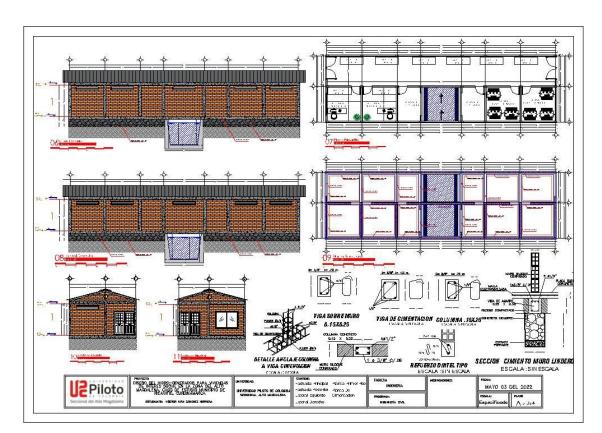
Plano A3-4 Plano de la Casa de Operación.
